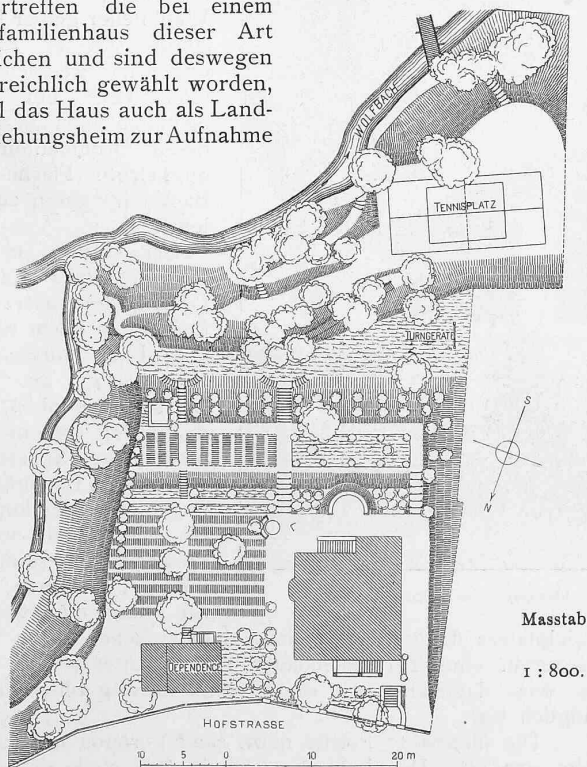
Lageplan der Villa «im Oberland» in Zürich V.
